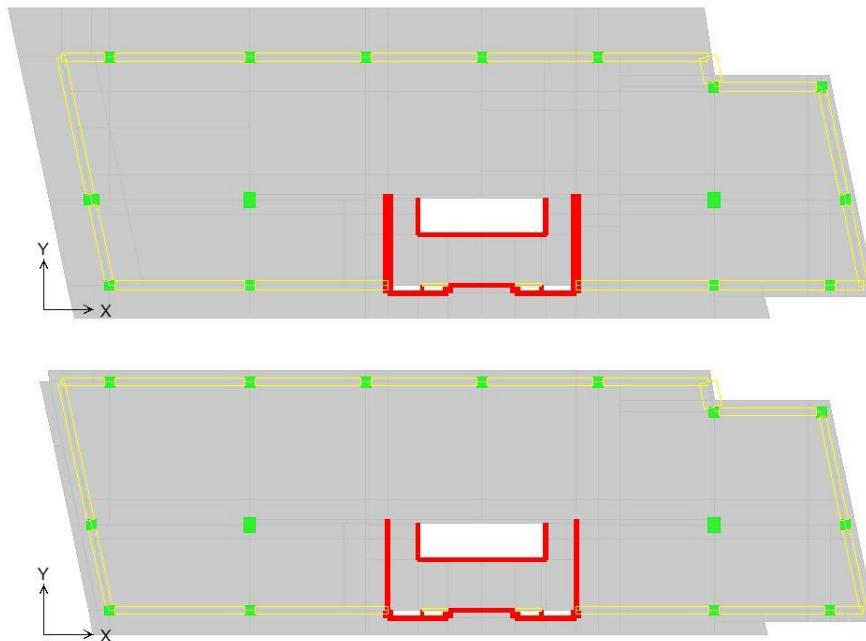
Planta primer piso (arriba) y piso tipo (abajo) edificio O3
